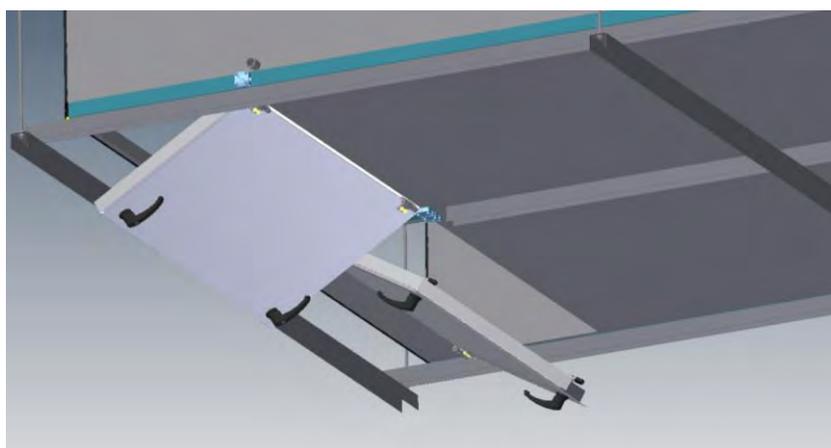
Suspension avec une combinaison de profils transversaux et longitudinaux
